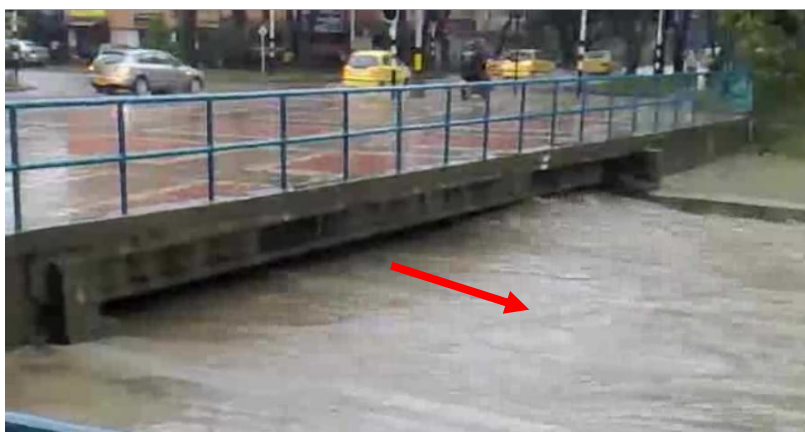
Córrego La Hueso. Vista da estação do metrô Suramericana, com destaque na Carrera 65.
